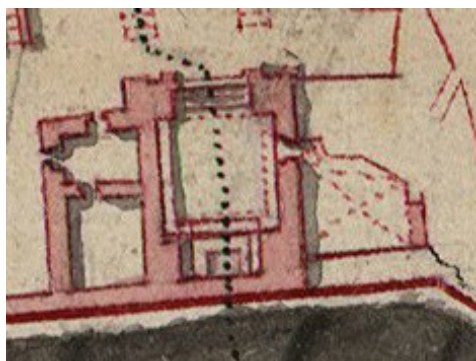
Planta de la capilla de la Santa Cruz, fragmento del *Plano del castillo de Santa Cruz de la plaza de Orán y perfil que pasa por la línea AB. de 1732 con la planta del fuerte*. AGS, MPD 16-063 y MPD 16-064
